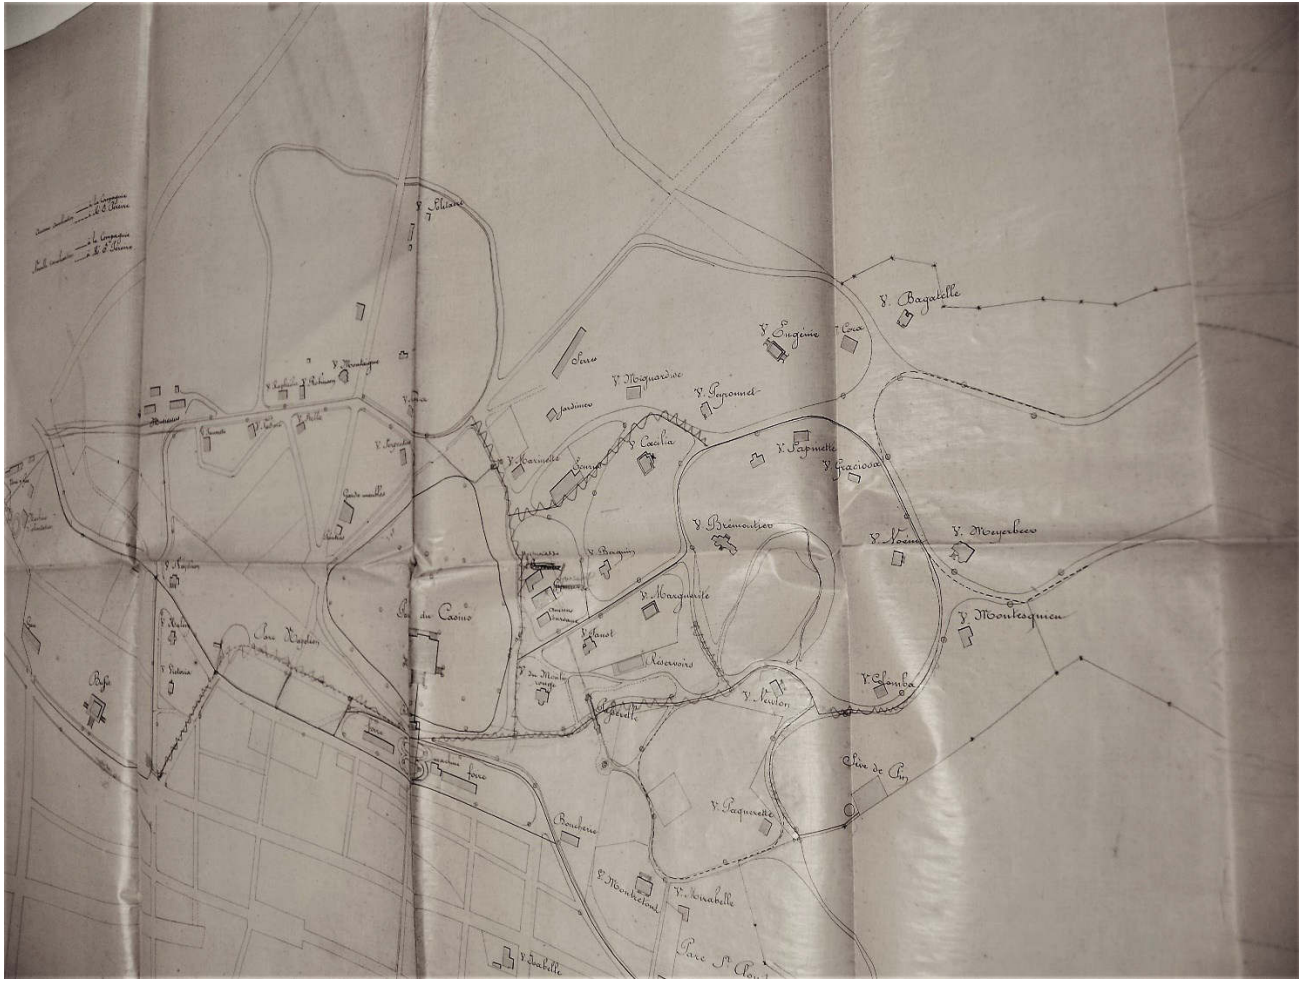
Plan Général- Extension de la canalisation du gaz- Ville de la forêt, 16 janvier 1864, CAHM, boîte 1137
